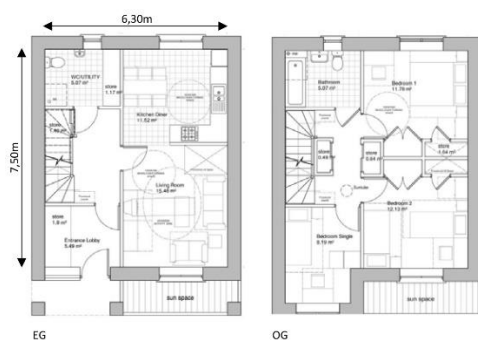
Grundrisse (Architekten: PRP Architekten) [2]
